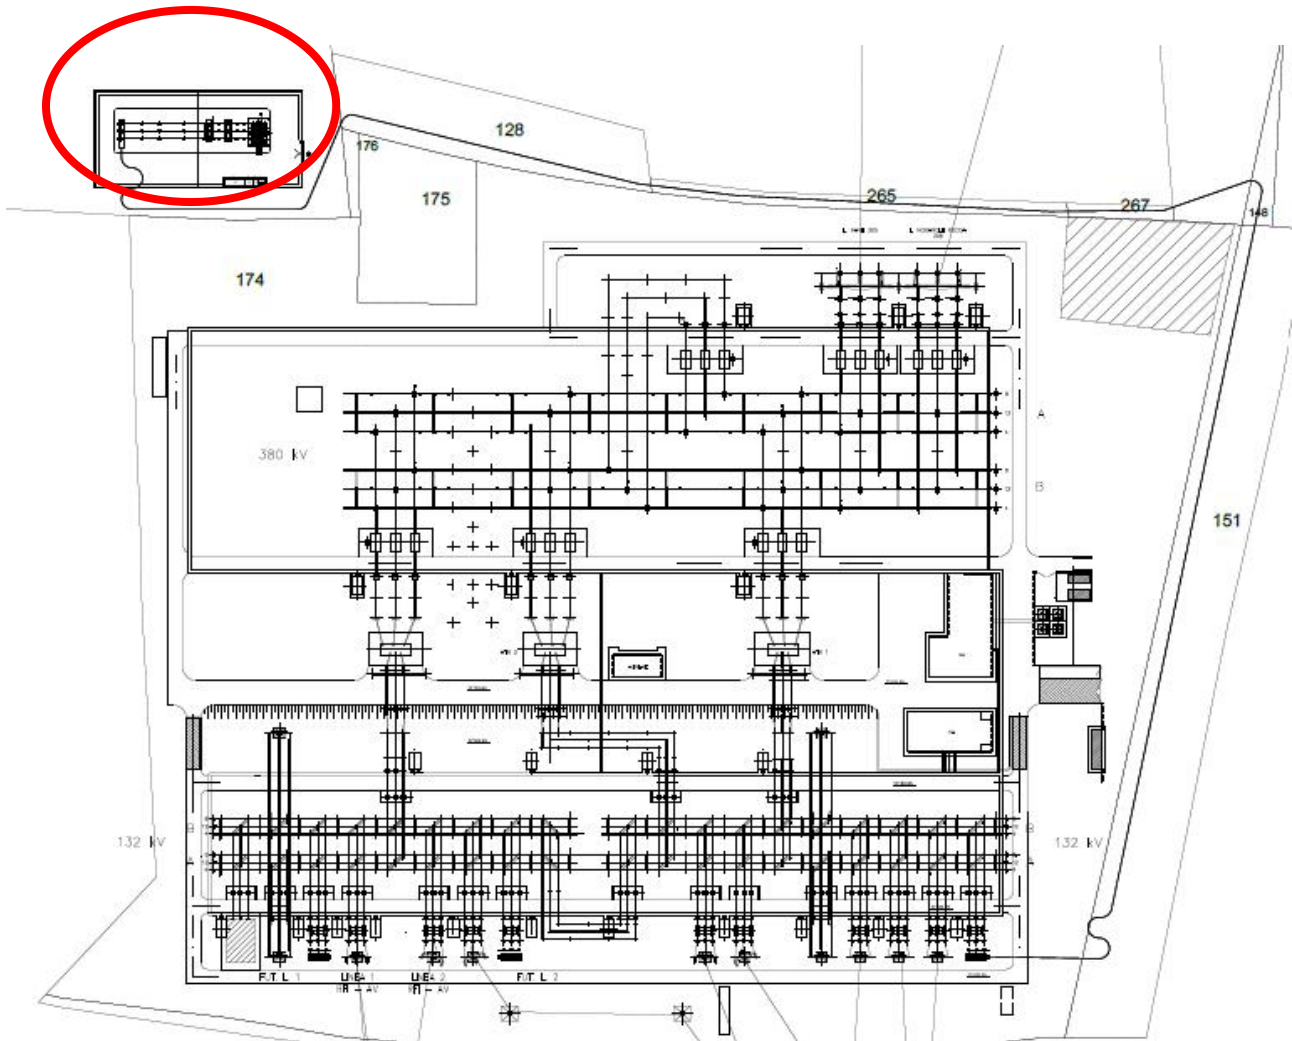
la sottostazione in progetto (nel cerchio rosso) rispetto alla centrale ENEL
